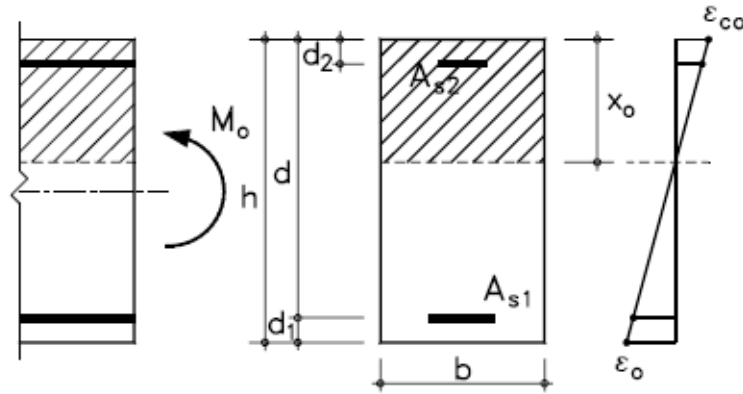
Situação inicial de seção de betão armado antes do reforço
